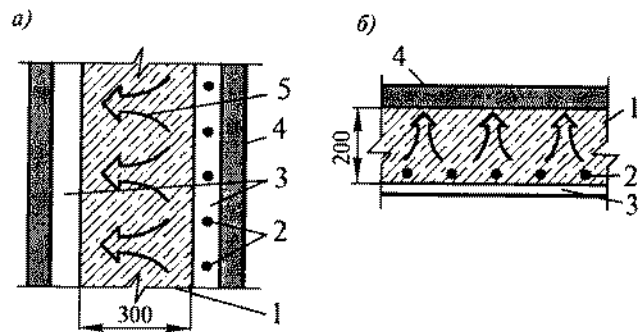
Схемы контактного нагрева монолитных конструкций:
